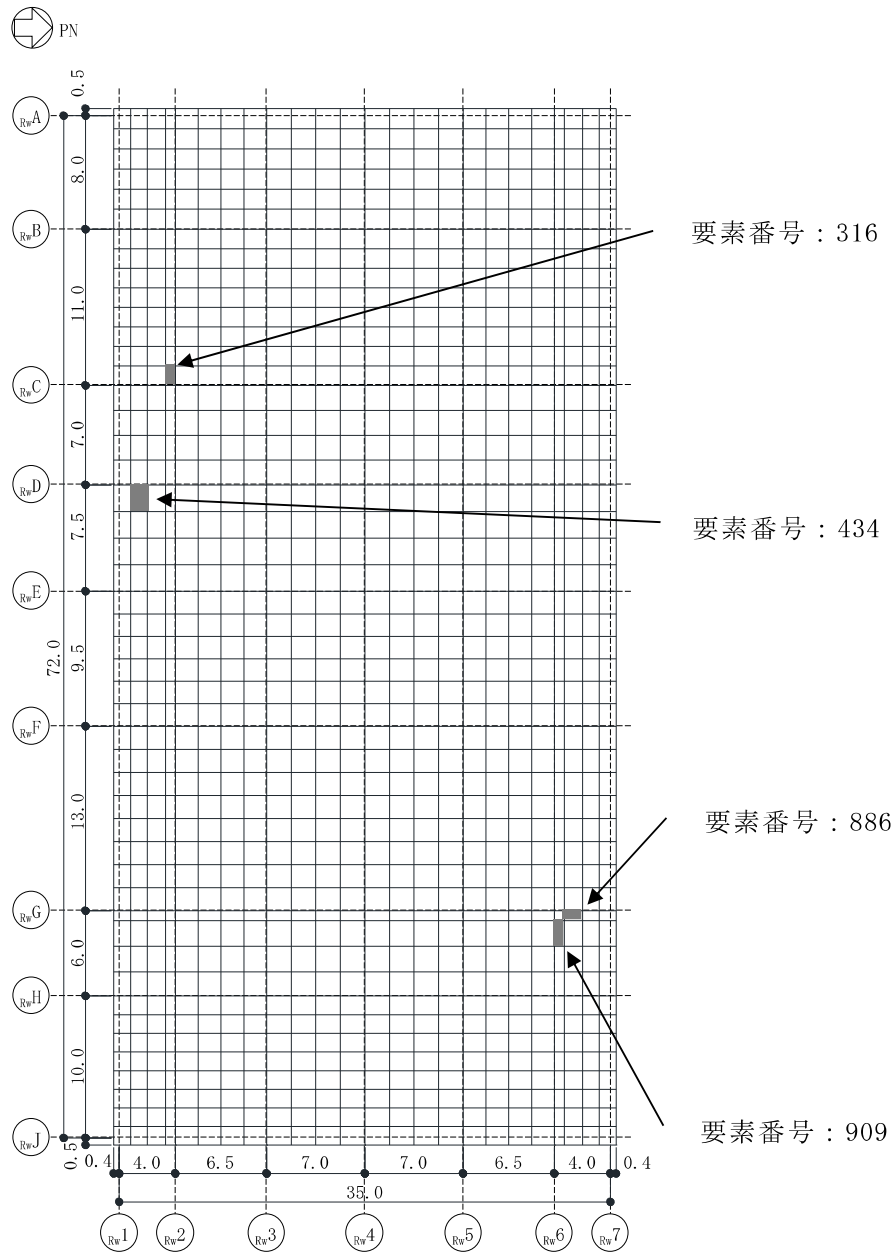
基礎スラブの配筋領域図 (せん断補強筋)
